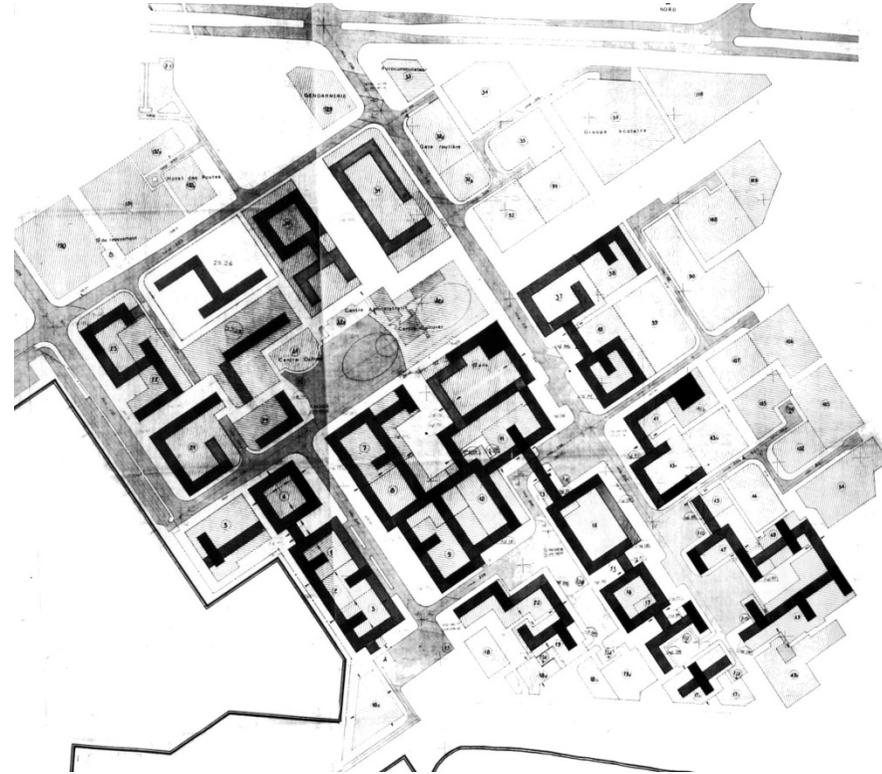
Plan de Masse del primer tranche (centre-ville)
